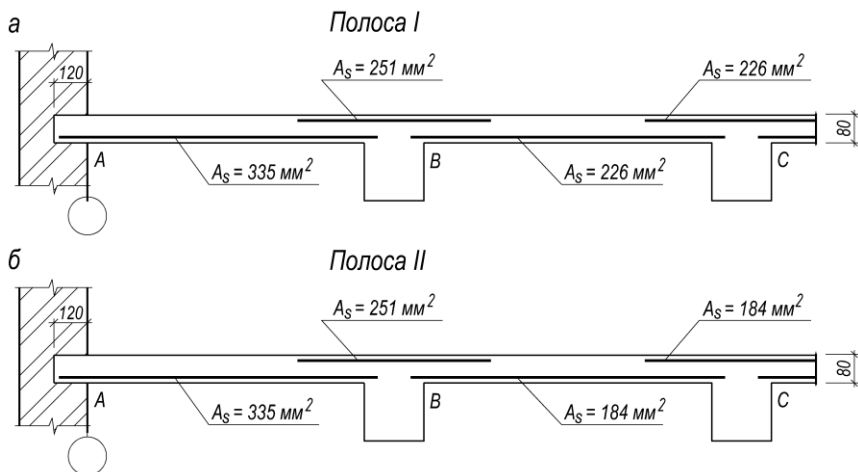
Площадь арматуры плиты, принятая по расчету
